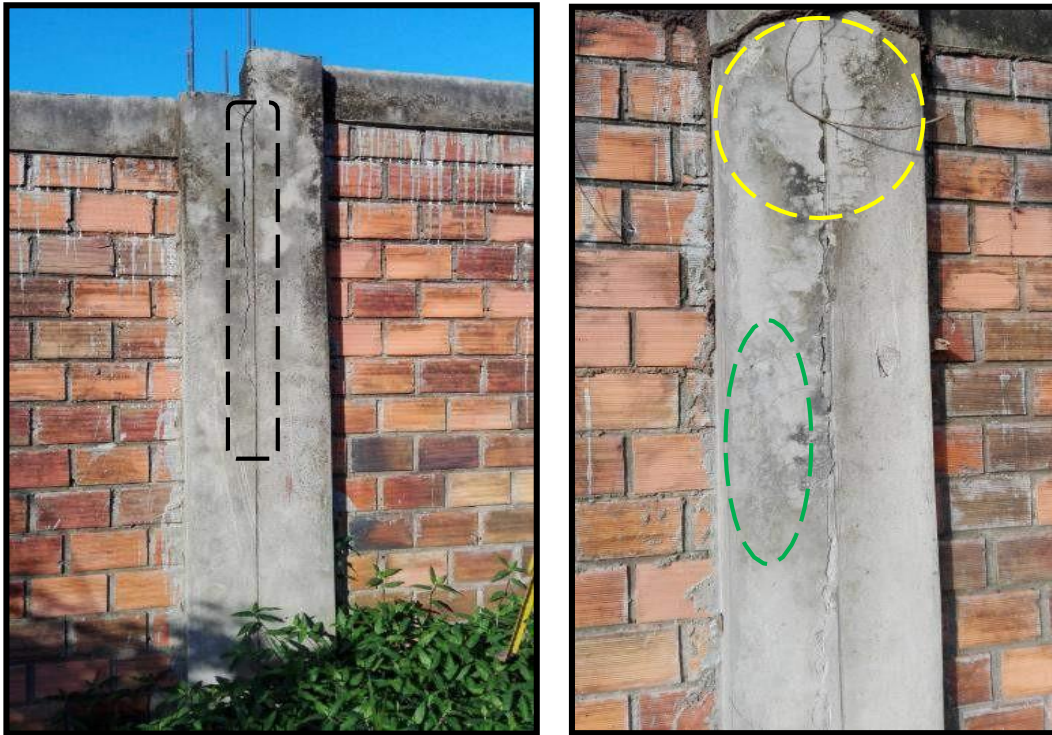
Se observa un agrietamiento vertical y fisuras diagonales en columnas.
